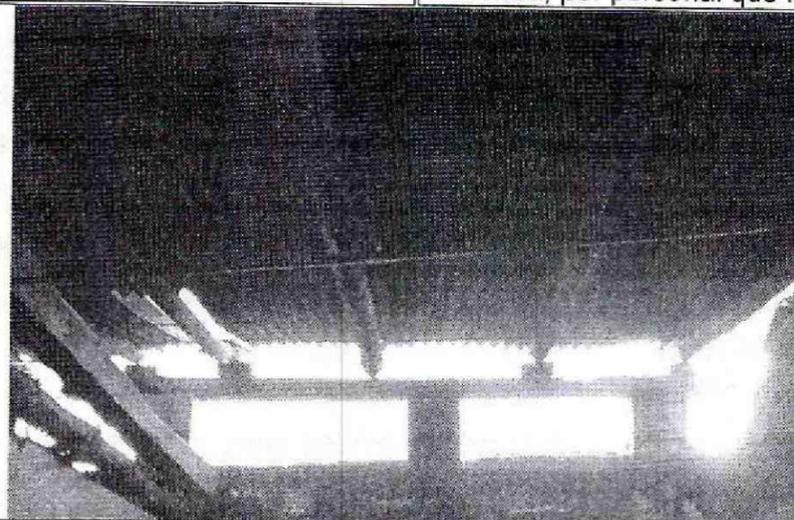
Vista interior del entramado en madera y cubierta teja de asbesto-cemento, de la vivienda emplazada en el predio de la Calle 1 No. 5 – 26.
